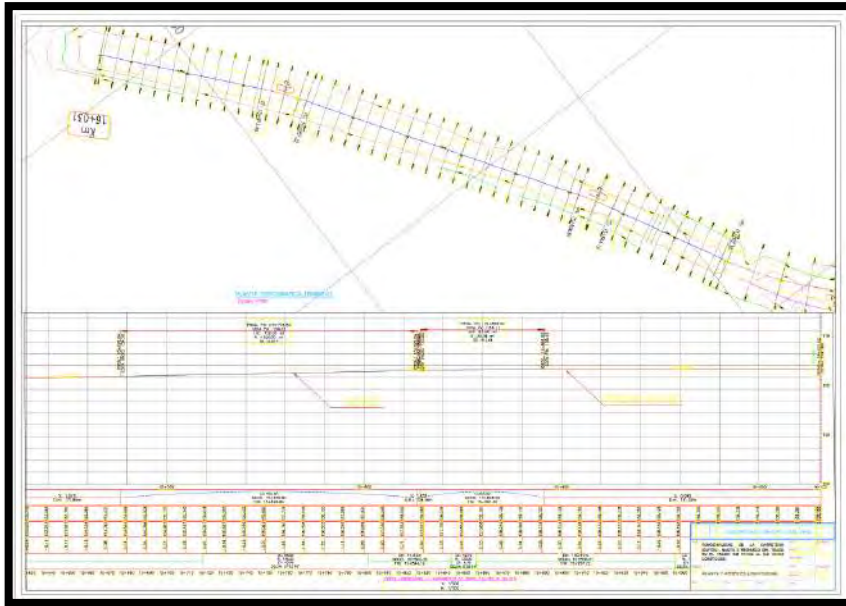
Plano de Planta y Perfil km 15+800 al km 16+000
